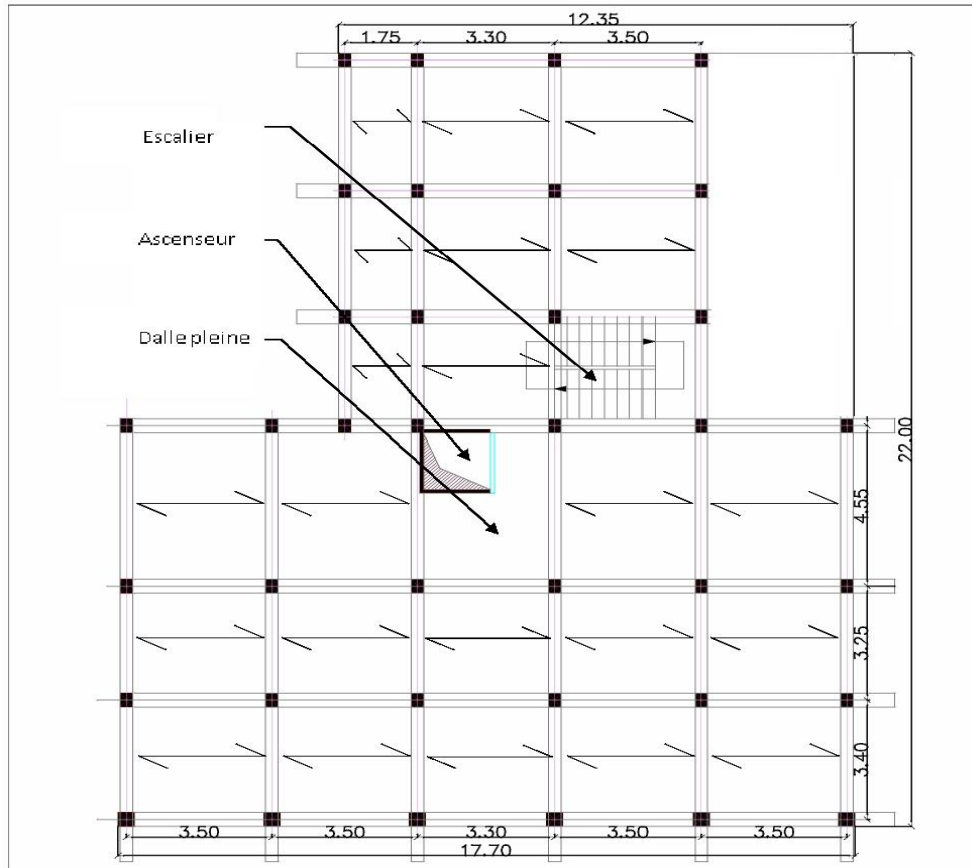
schéma de disposition des poutrelles des étages courants.
